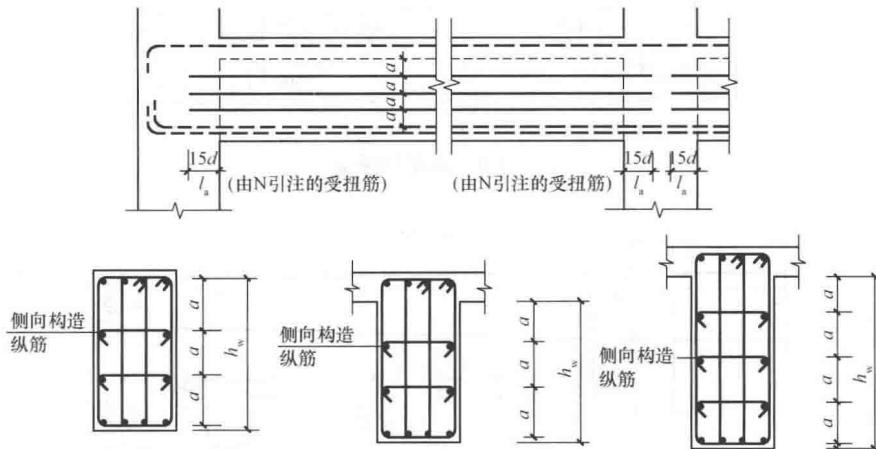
梁侧面纵向构造钢筋和拉筋构造
